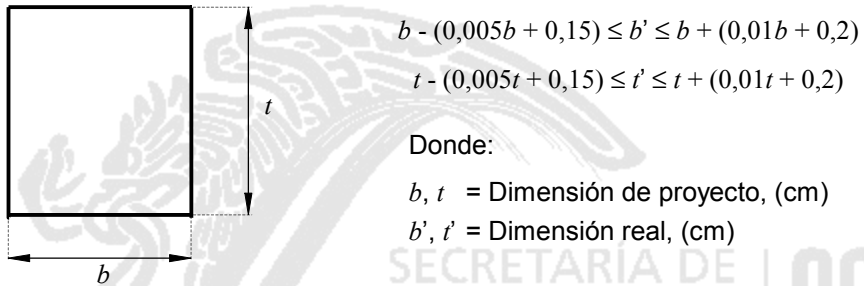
Tolerancia para la sección transversal de trabes o columnas
